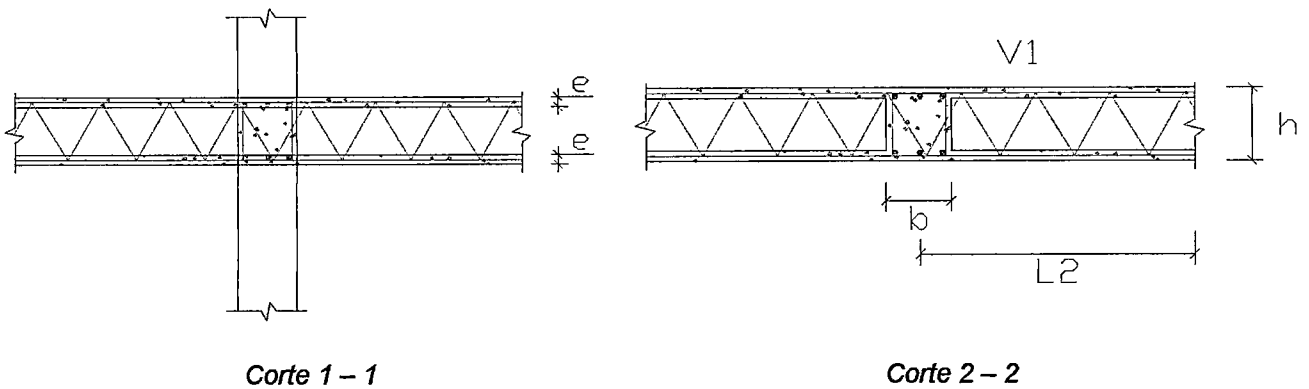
Detalles Típicos de una Edificación que emplea Tridilosa (Estructuración B)
